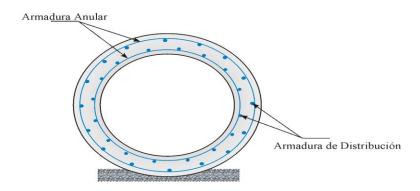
(1). Tubo en concreto armado Fuente: Macaferri
